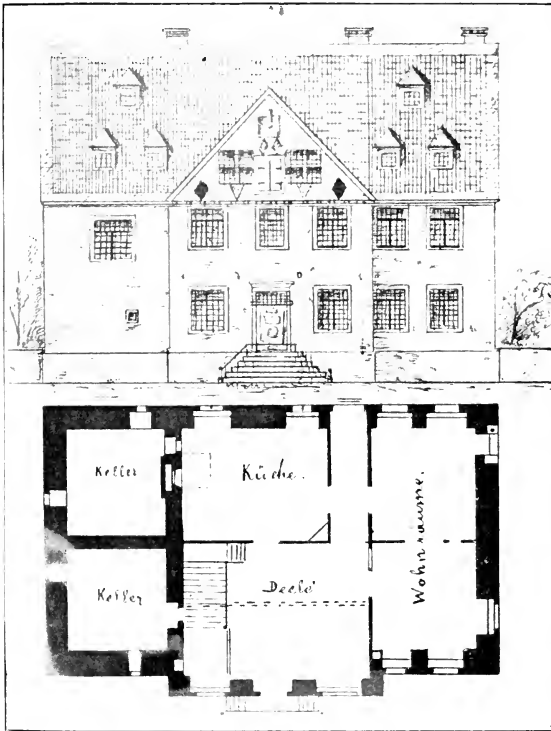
Grundriss und Ansicht eines Barmer Hauses von 1701.
